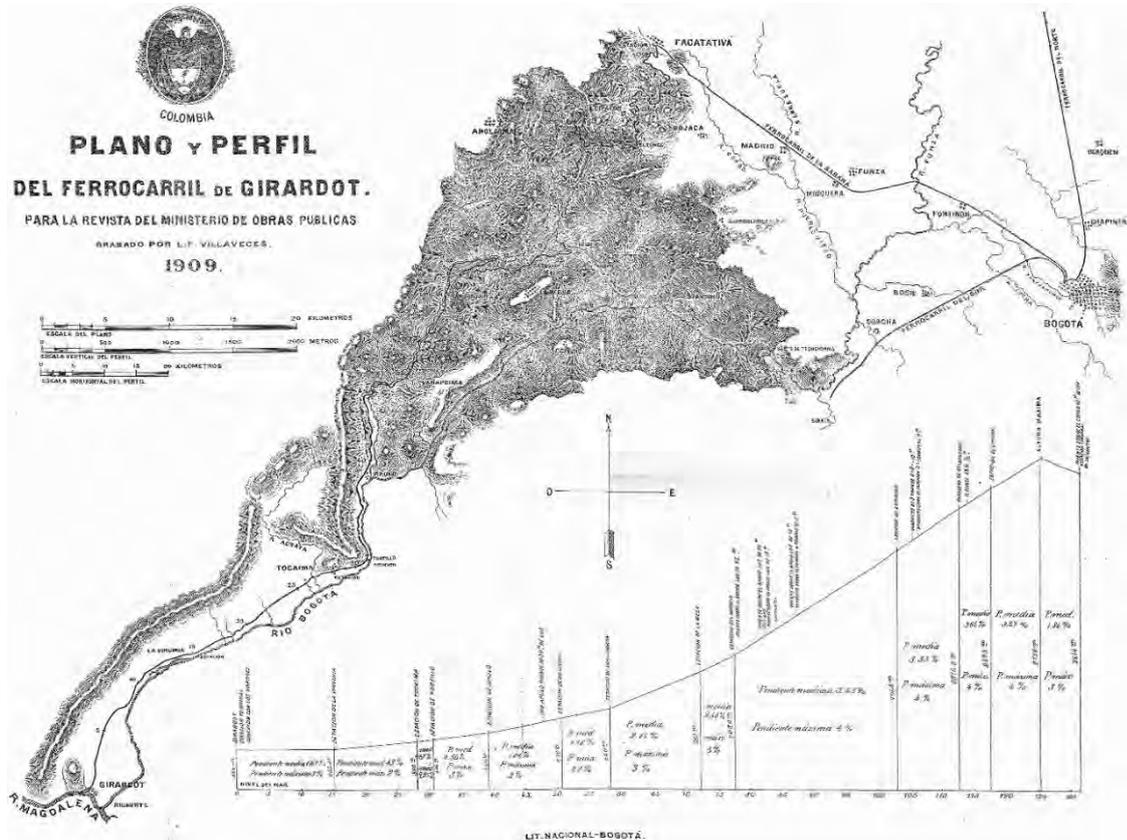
Plano y perfil del Ferrocarril de Girardot. Tomado de Ministerio de Obras Públicas 1909
